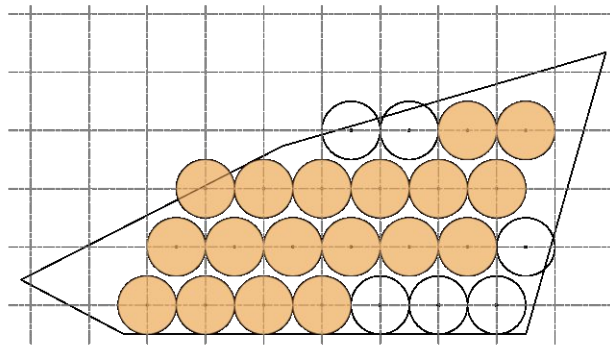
gewisse Pilzstützen für 2.Obergeschossfläche
